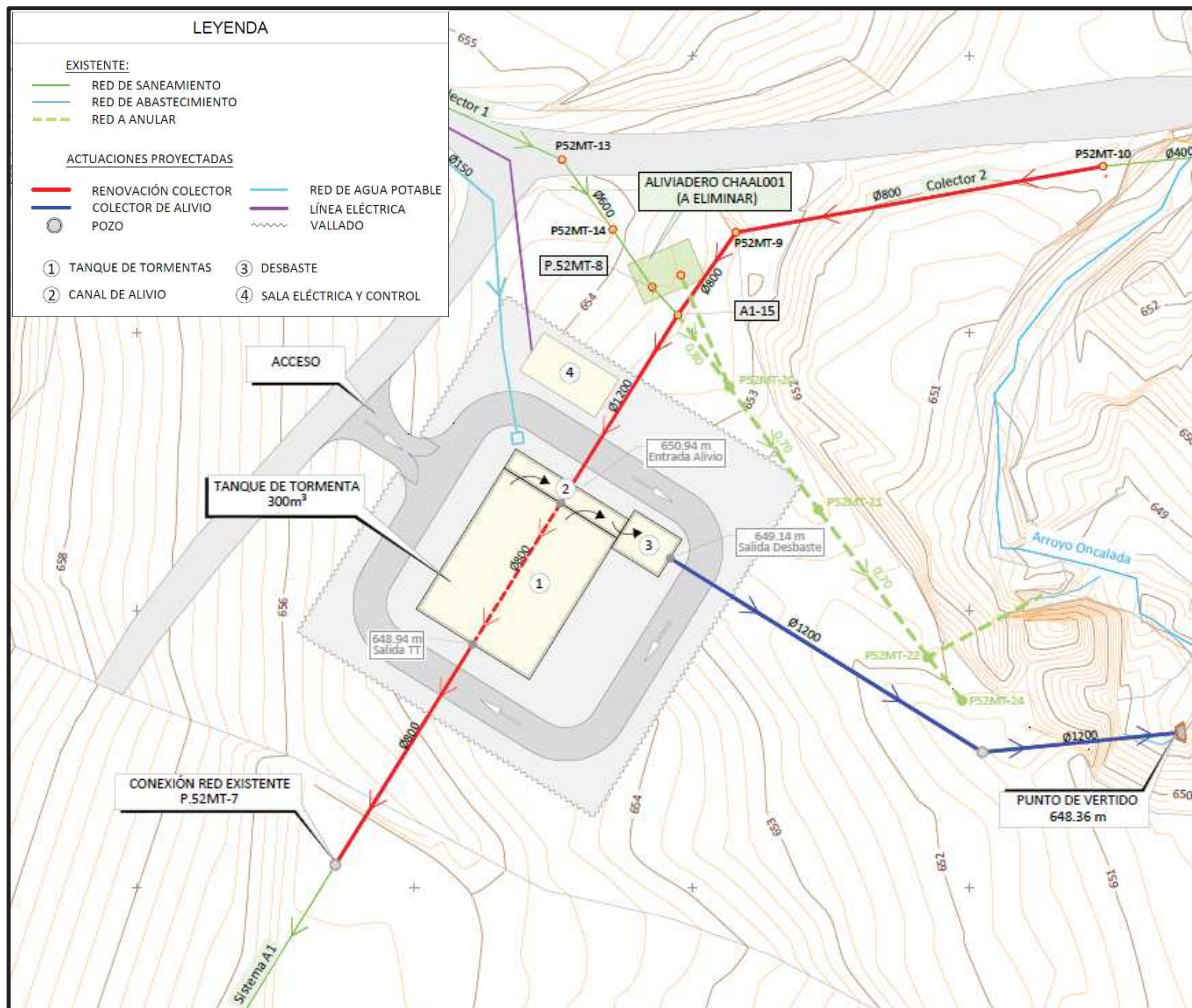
Planta general de la actuación. Fuente: plano nº 2 de la documentación presentada.
